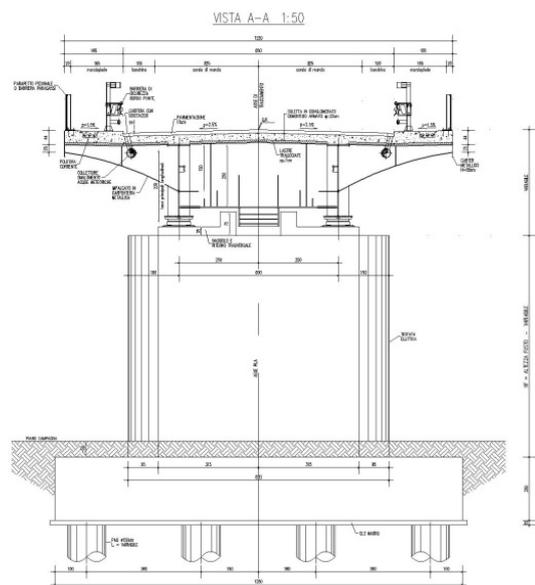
C – VISTA FRONTRALE PILA.
